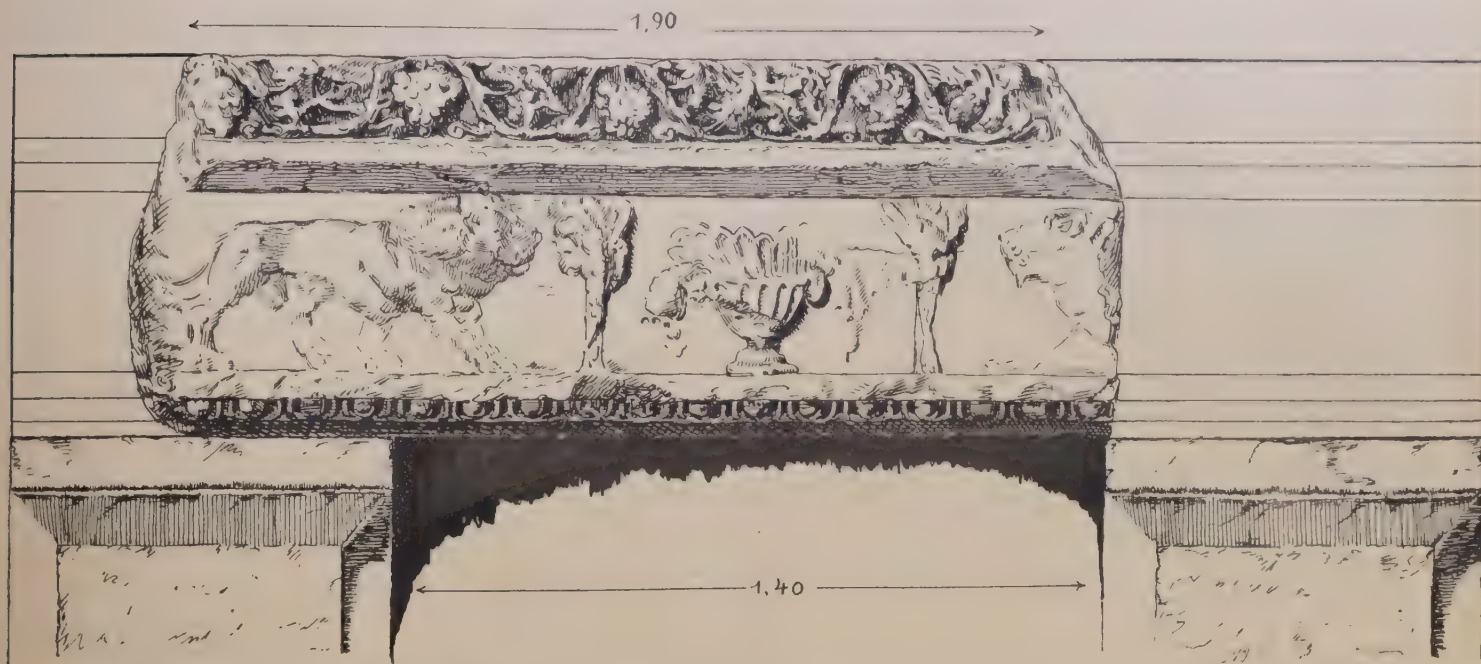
Porte sud-ouest de la façade (reconstruction).
